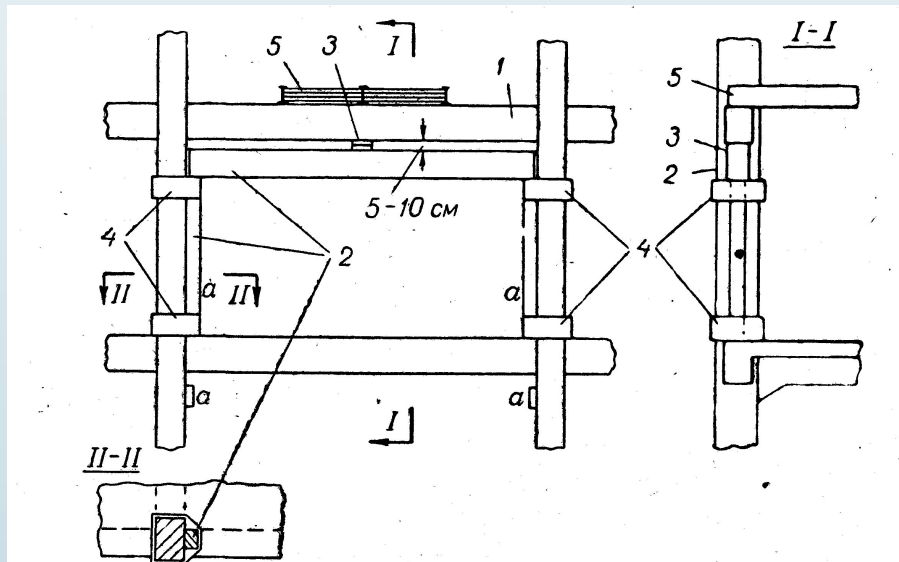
Усиление железобетонного ригеля междуэтажного перекрытия устройствам дополнительной жесткой опоры с вариантами узлов:
